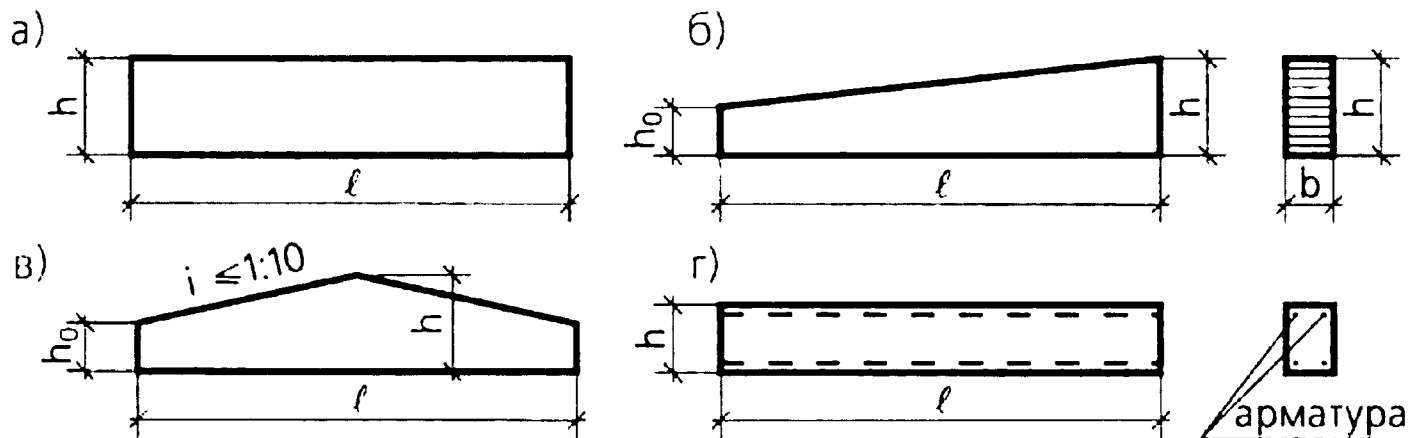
Дощатоклееные балки: а - с постоянной по длине высотой сечения; б - односкатная; в - двухскатная; г - армированная стальной арматурой
